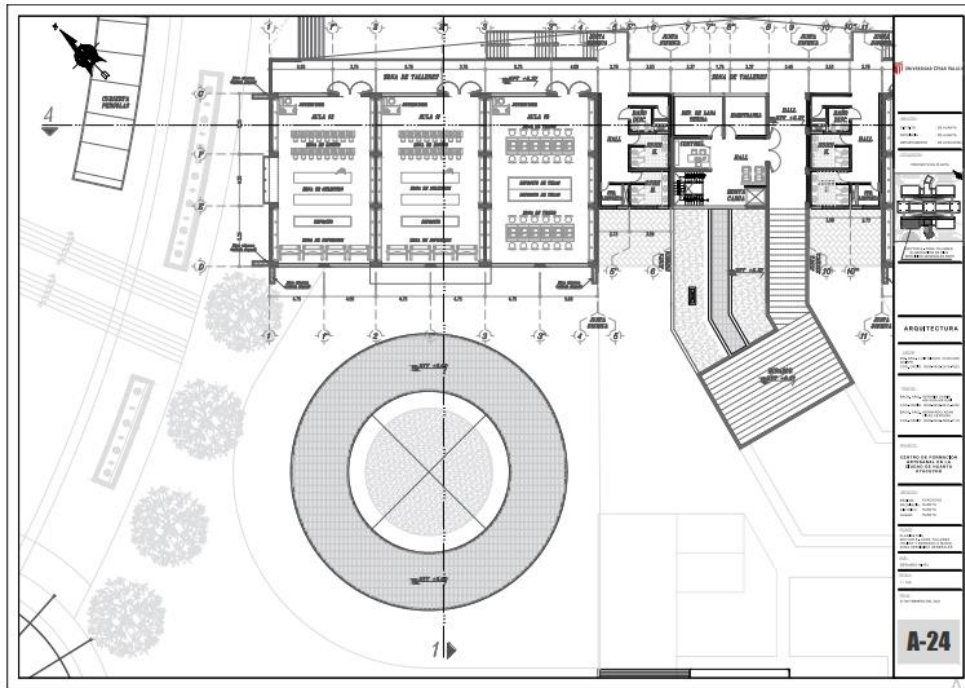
Planimetría del sector 6 ubicado en el piso 2. Escala 1/100.
